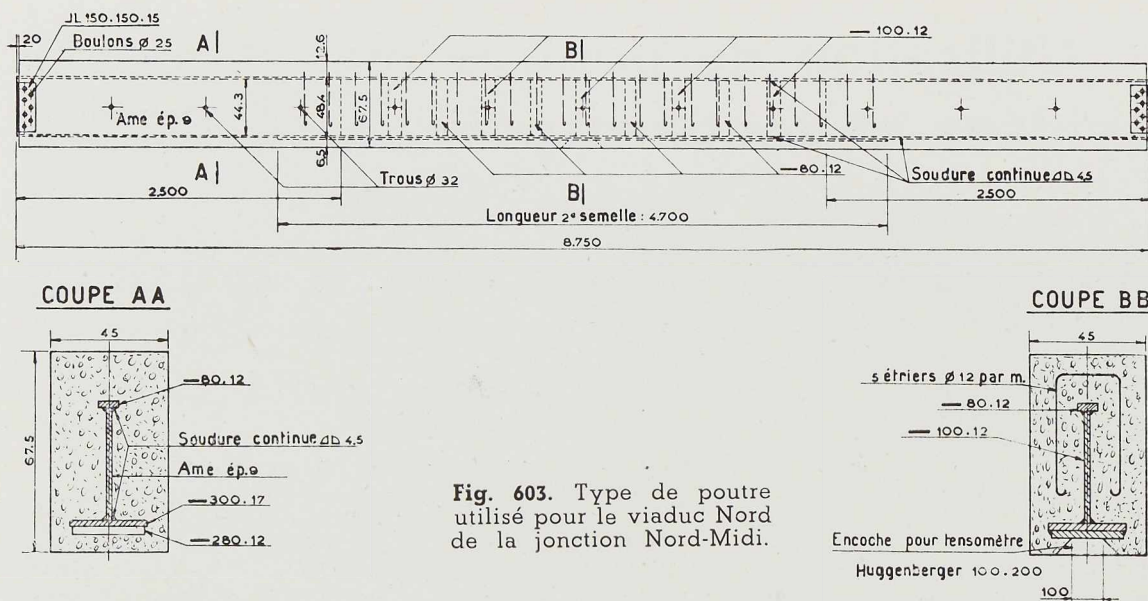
Type de poutre utilisé pour le viaduc Nord de la jonction Nord-Midi.
